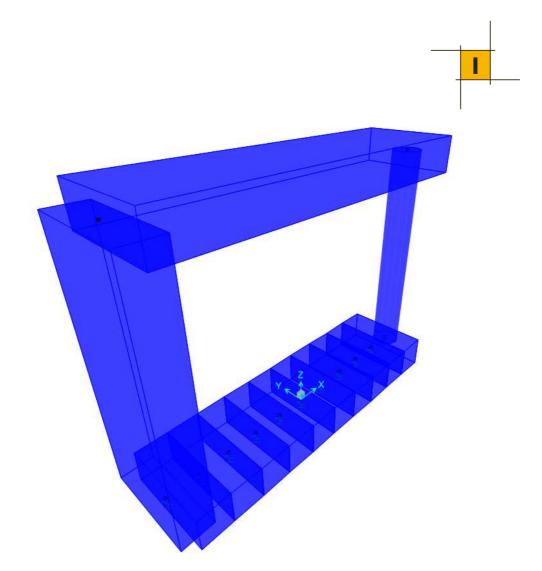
Modello bidimensionale, vista estrusa, della porzione di galleria analizzata su Sap2000
